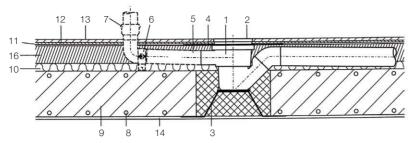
Pose avec tôle de raccordement montée dans un évidement, sol avec revêtement en PVC
